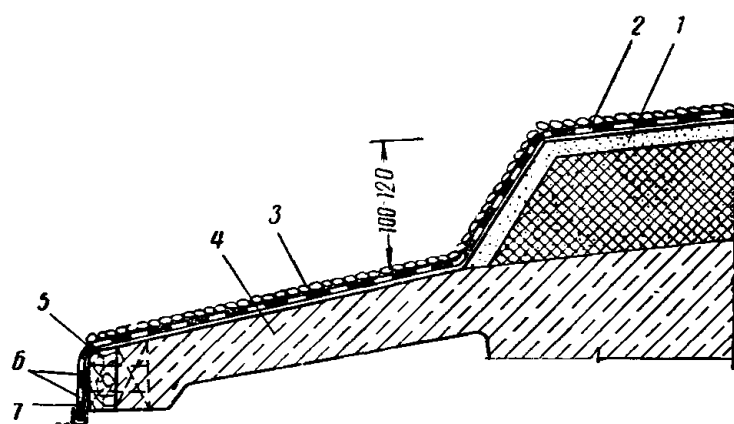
Устройство кровли из рулонных материалов на карнизе при наружном водостоке
